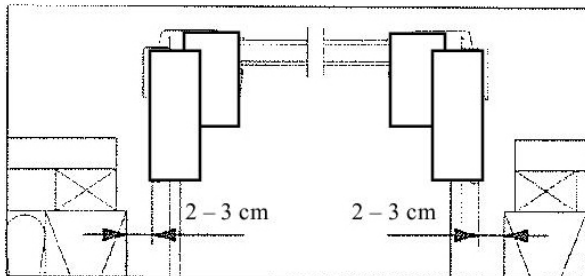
Abstandsmaße der Dachsparren bei wärmetechnischer Verbesserung
